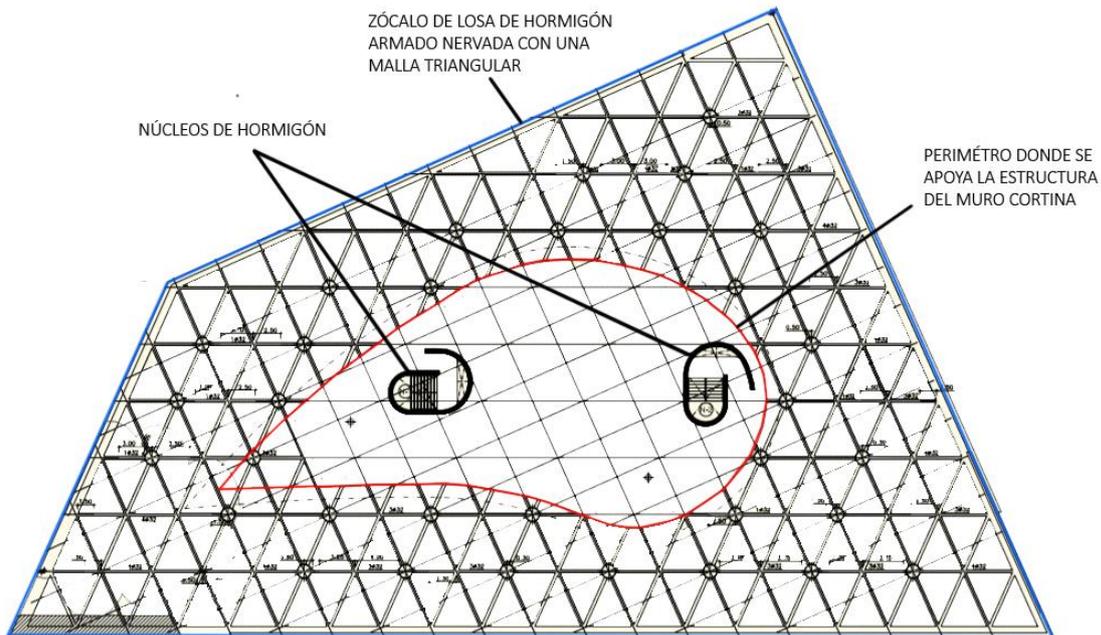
Esquema estructural del zócalo en planta. Elaboración propia.
